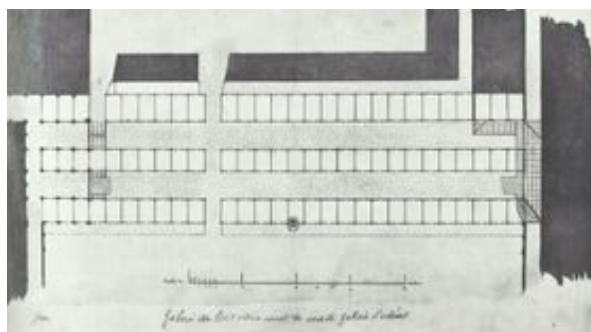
Galerie de Bois; Grundriss, um 1828
